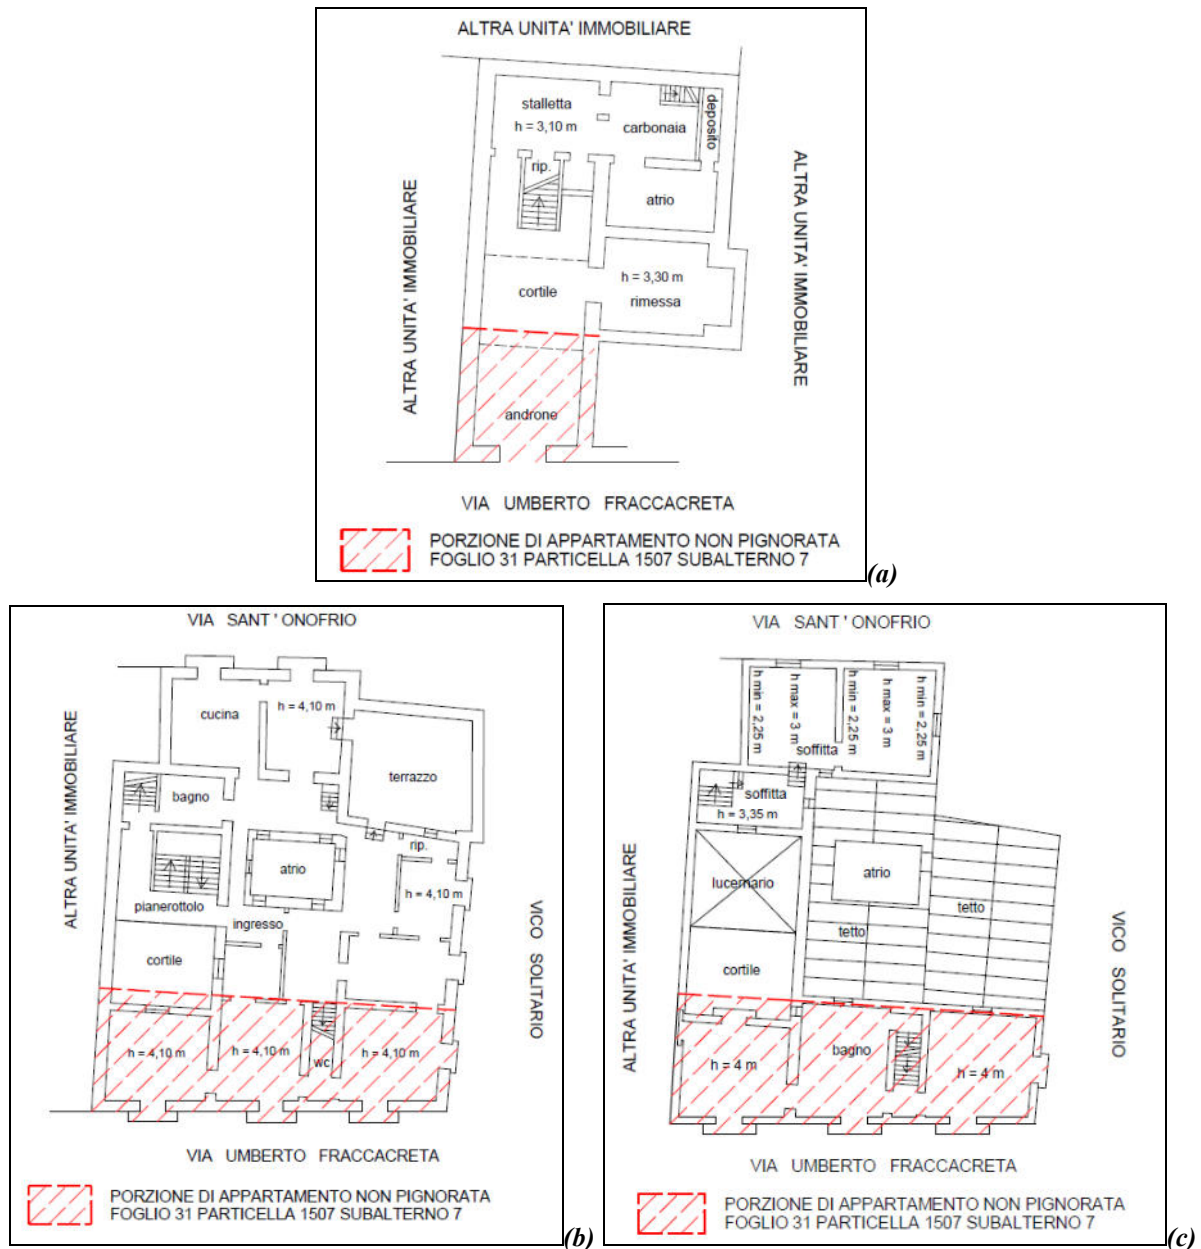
Planimetrie attuali dell'appartamento ad uso abitativo ubicato in via Umberto Fraccacreta n° 10: piano terra (a); piano primo (b); piano secondo (c).
